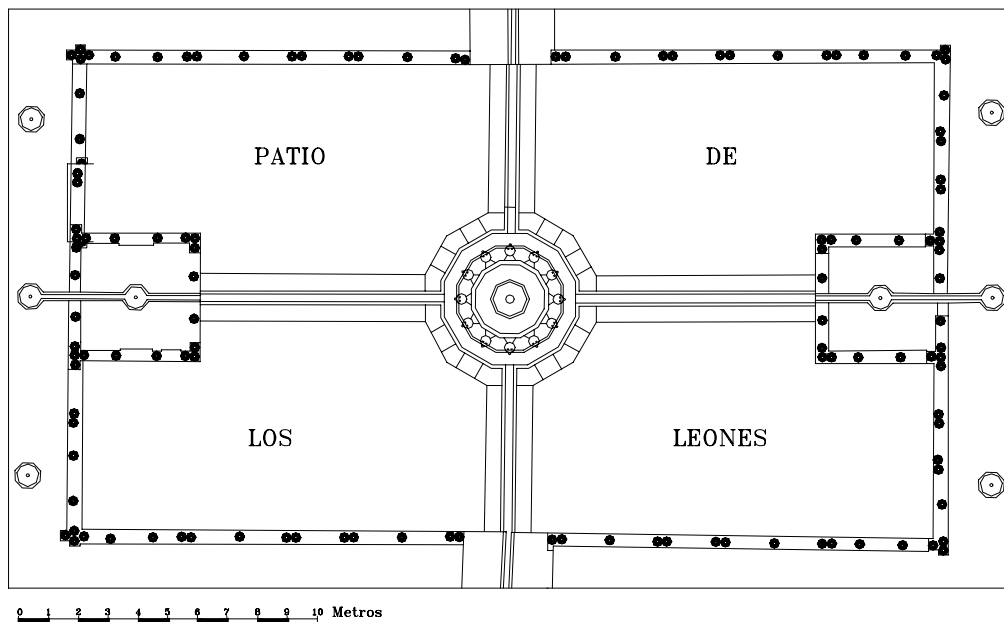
Plano de planta del Patio, columnata y templetos que definen los límites del anillo perimetral interior.
